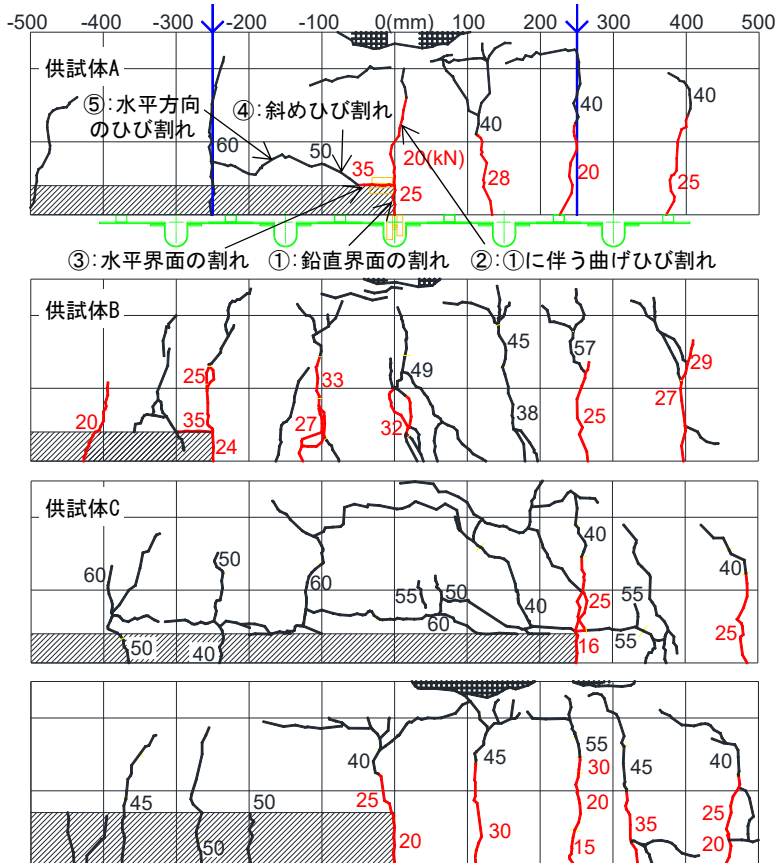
ひび割れ図 (数値は目視により確認した発生荷重)
